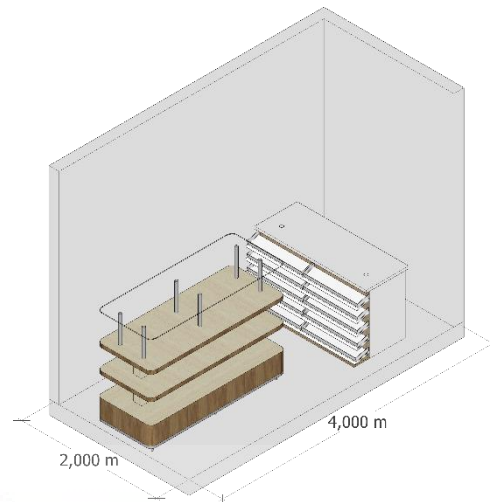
Layout *Tenant* 4×4 meter Klaster Kosmetik serta Hobi dan Seni
